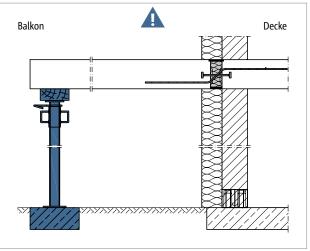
Schöck Isokorb® T Typ QP: Stützung durchgängig erforderlich
